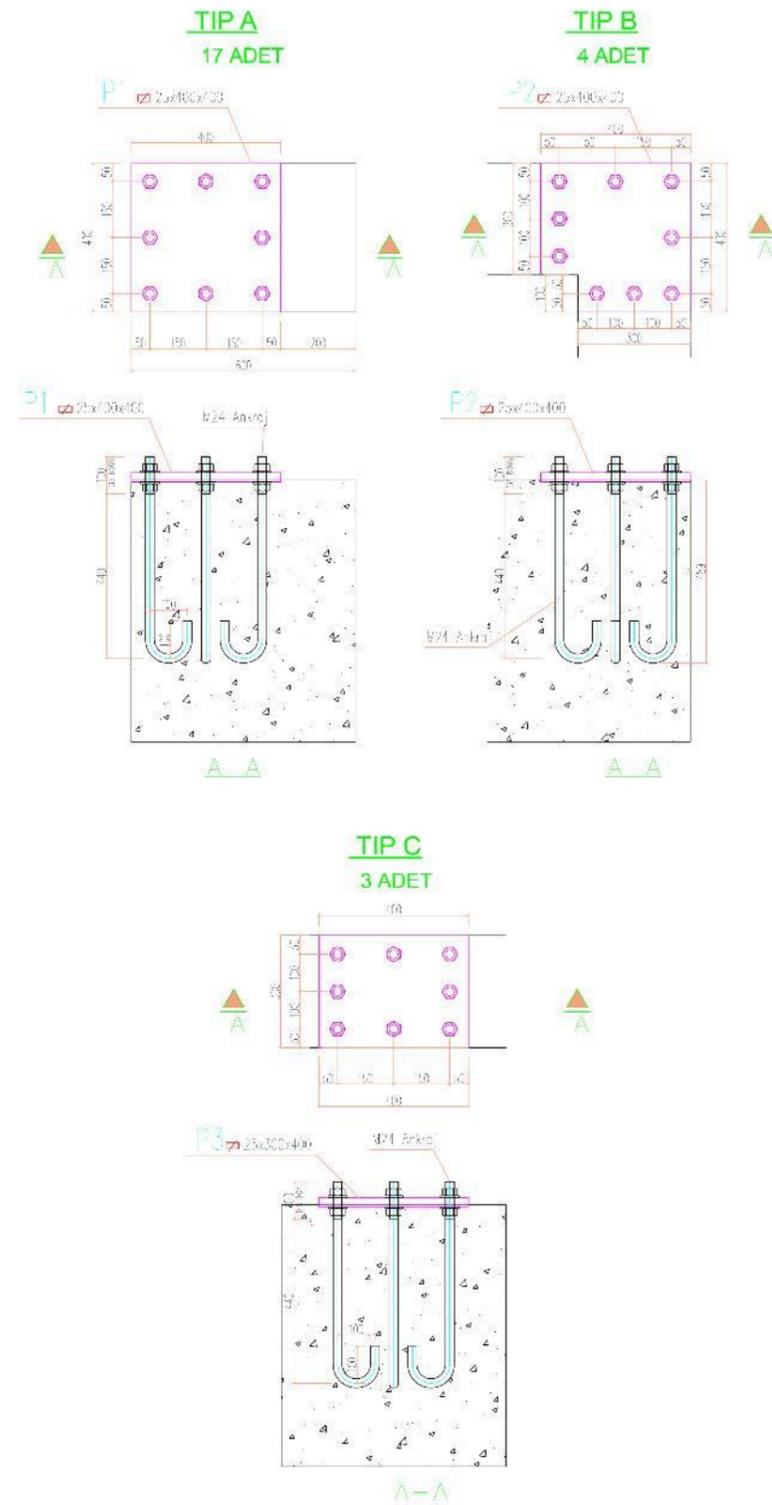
Détails fixation de poteau avec l'avant poteau.
